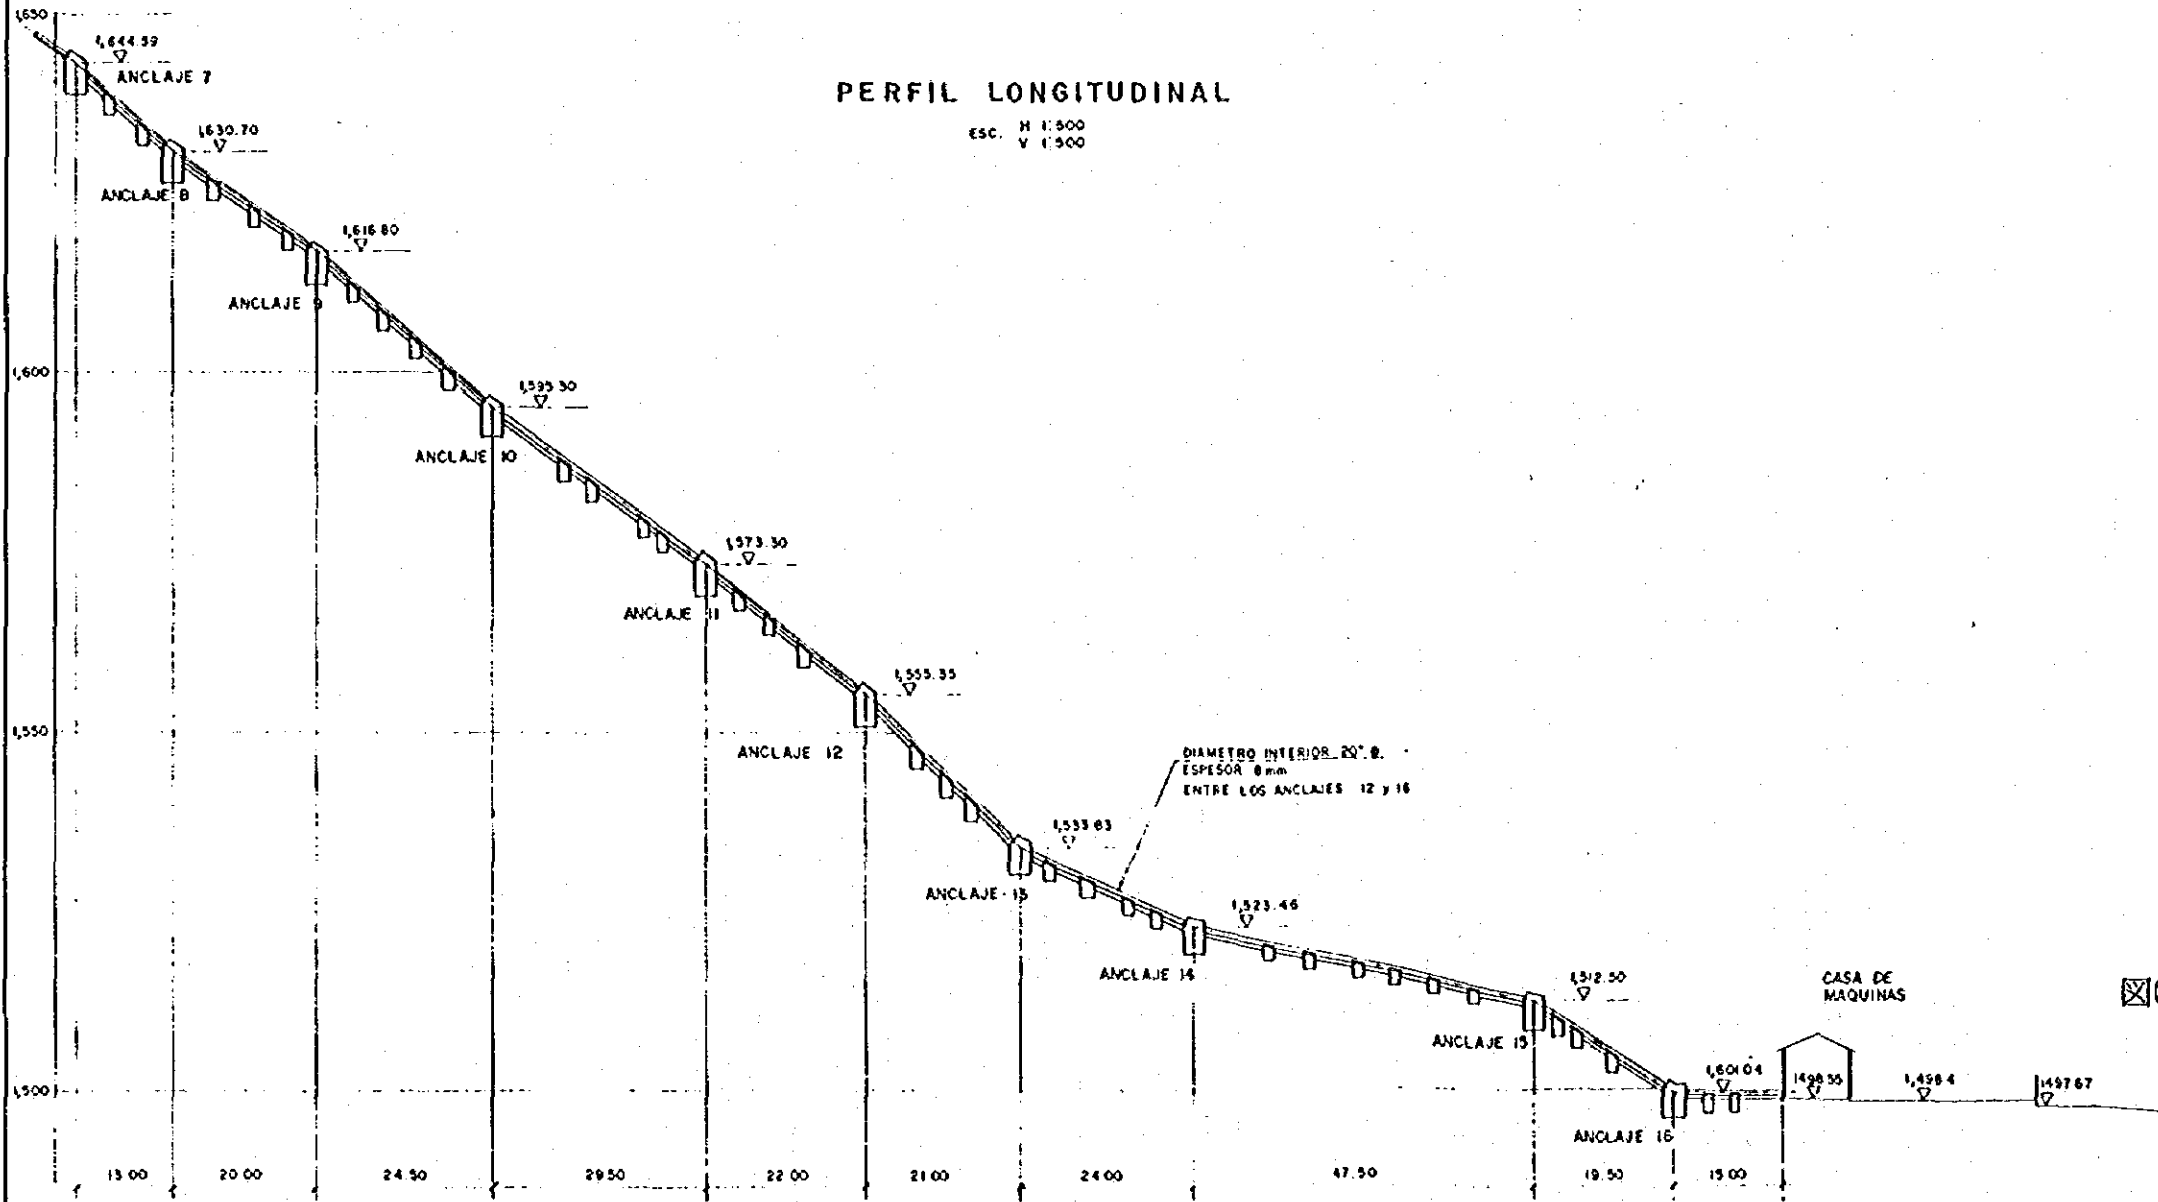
上水槽及び水圧鉄管路平断面図 (1/2)
